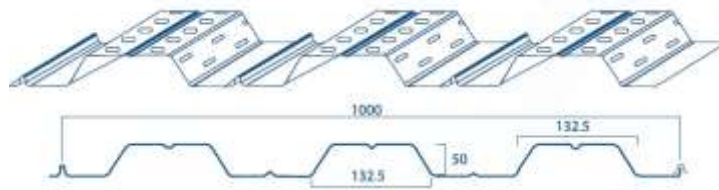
Sección Placa Colaborante. [Fuente: DIPAC]
